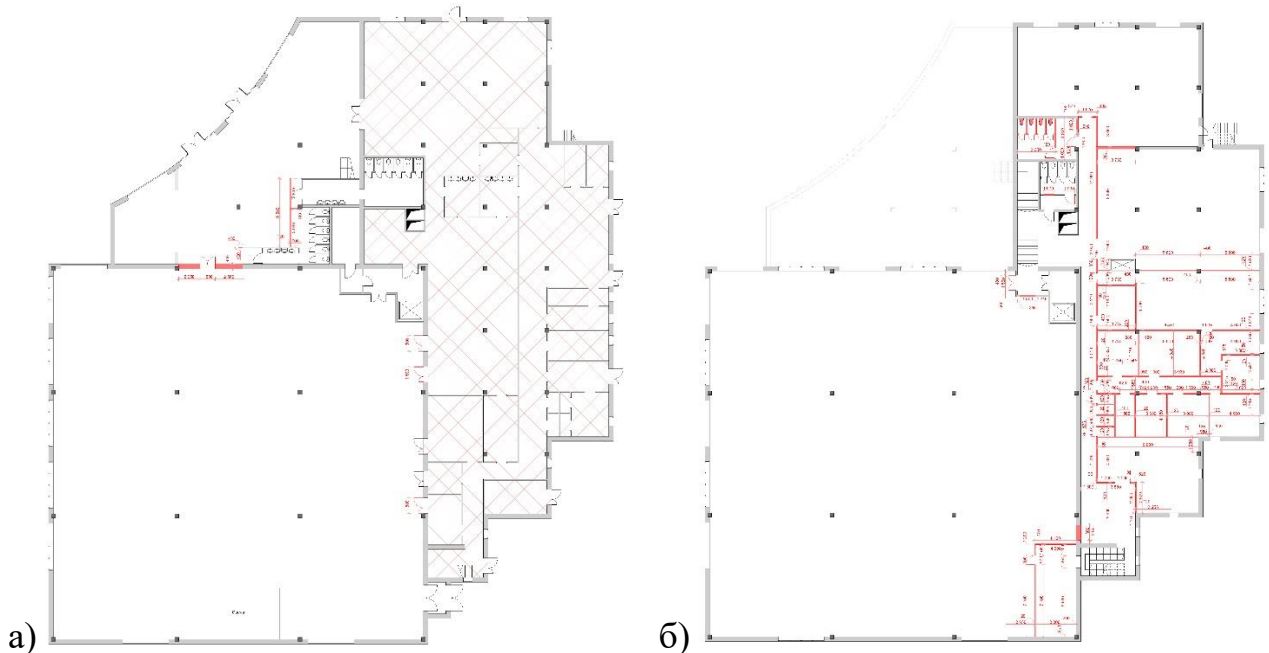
Плани демонтажу перегородок: а) перший поверх; б) другий поверх
